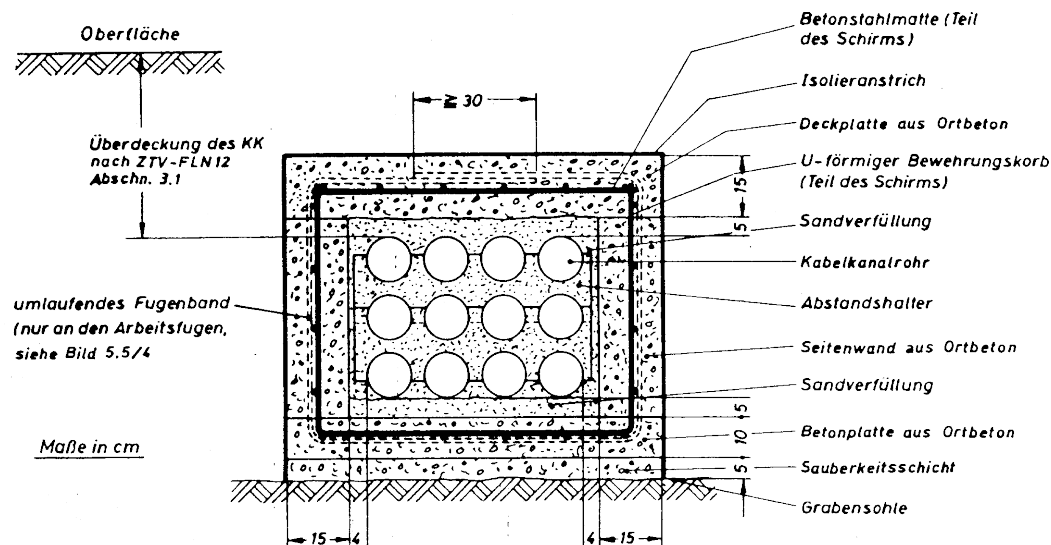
Aufbau eines KK aus Ortbeton in Blitzschutzbauweise
